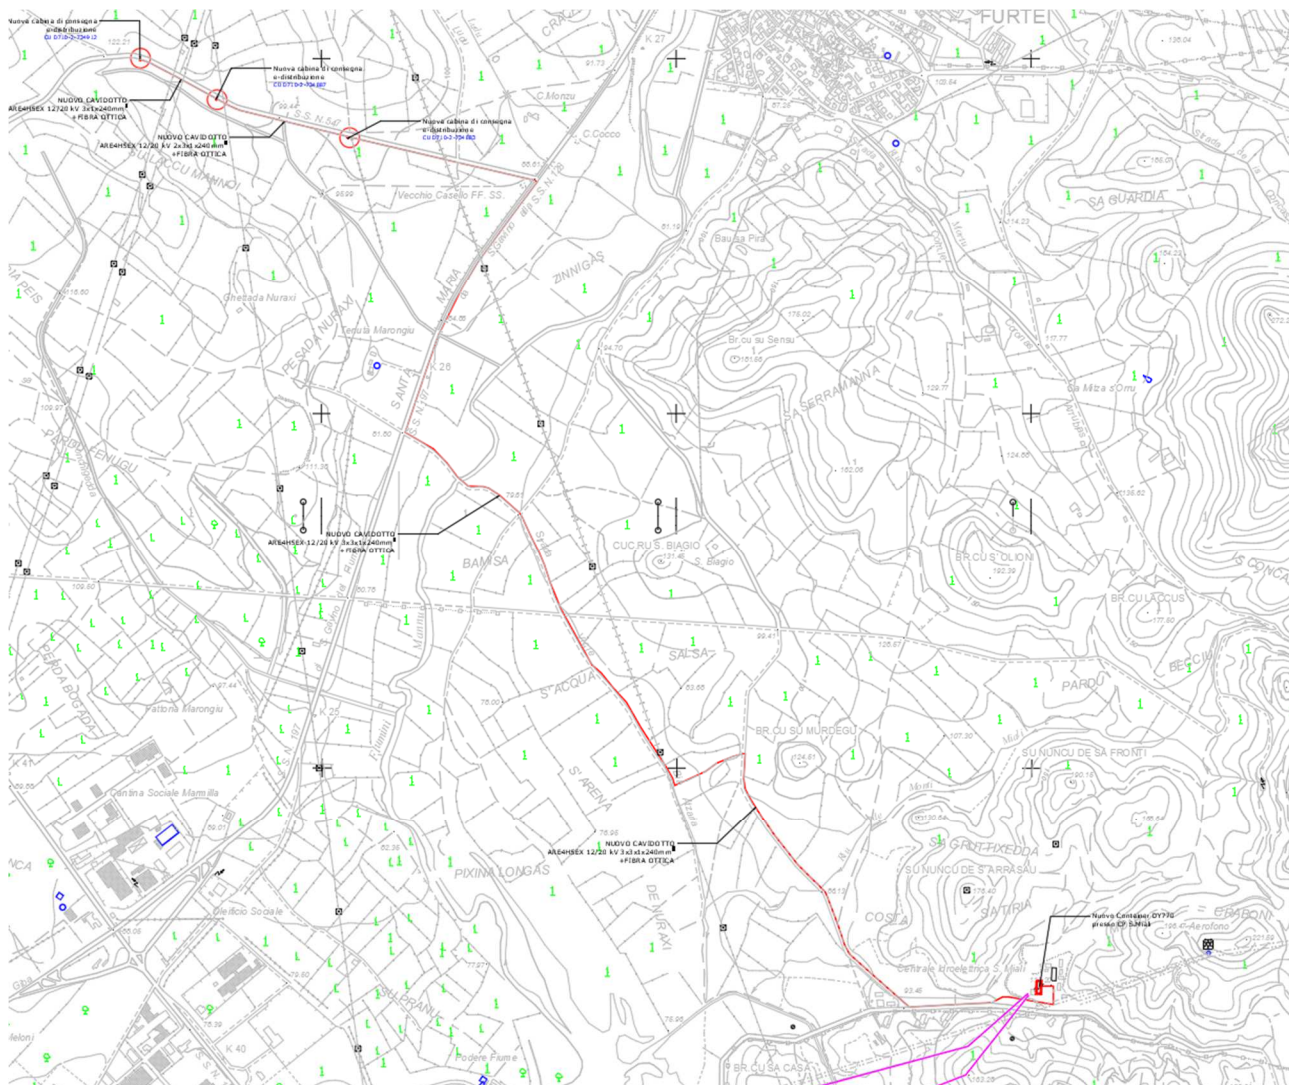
Stralcio planimetrico impianto di rete per la connessione impianto fotovoltaico.
